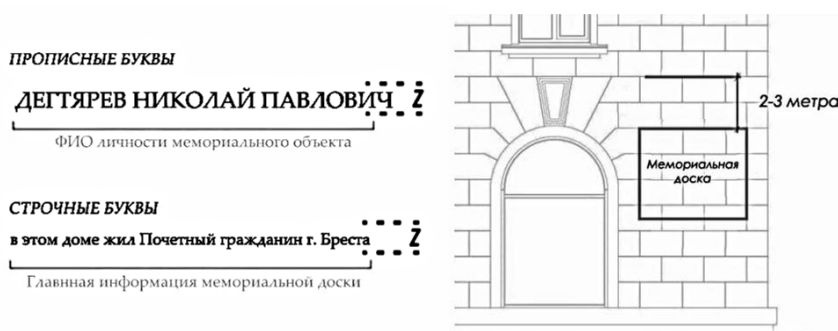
Рекомендованный шрифт и размещение вывески на фасаде здания
